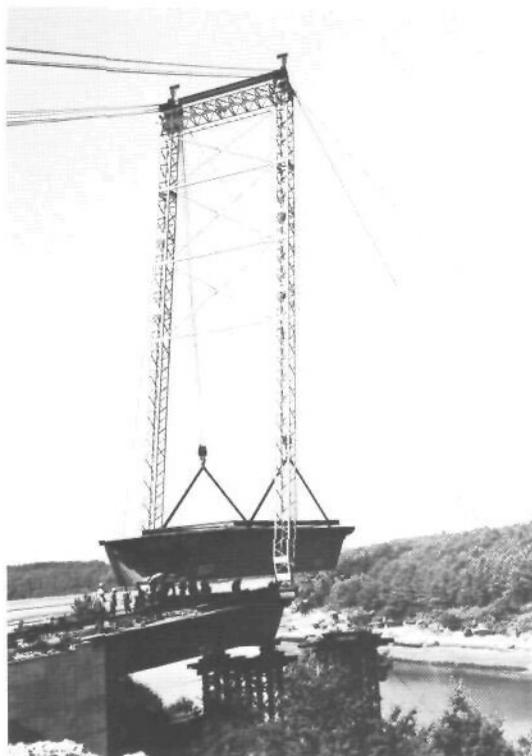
Les pieds du portique sont situés à l'extérieur du tronçon déjà posé, ce qui permet le passage du tronçon suivant. Dans cette position, proche de la verticale, il est nécessaire d'avoir des câbles « arrière » et « avant ». Les câbles arrière sont peu tendus.
